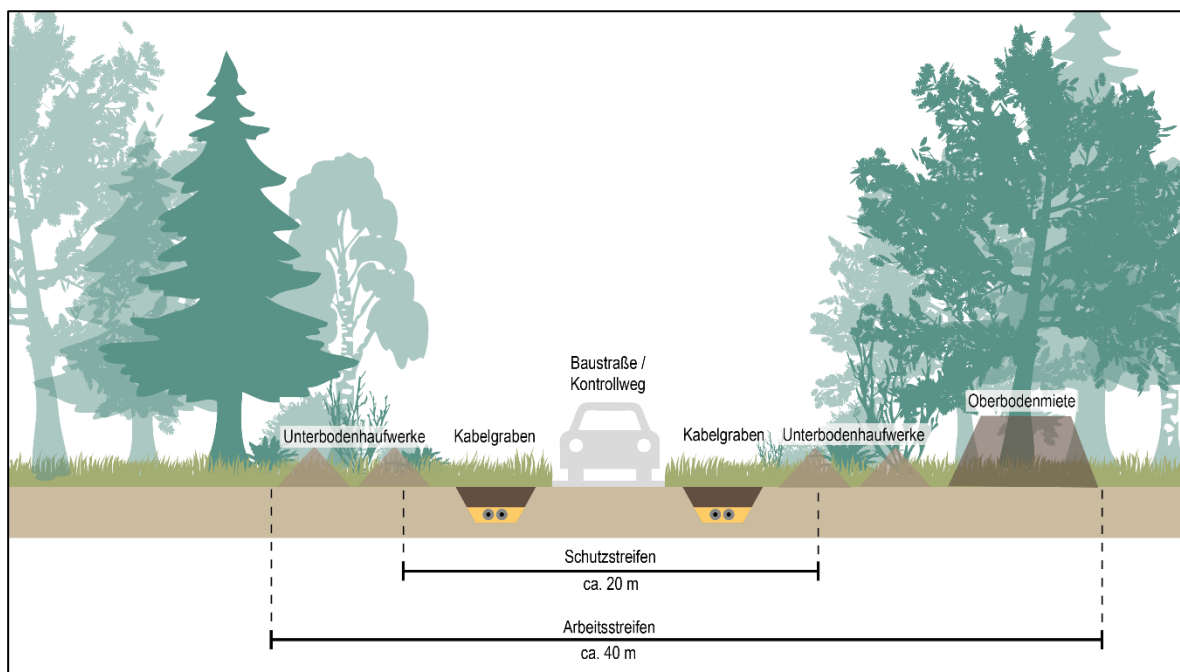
Beispielhafter Trassenquerschnitt einer 320 kV-Erdkabelanlage im Wald mit Arbeits- und Schutzstreifenbreite (Zwei-Graben-Bauweise mit jeweils zwei Schutzrohren unter Berücksichtigung einer zweifachen Unterbodentrennung und Anlage der Baustraße zwischen den Kabelgräben)
